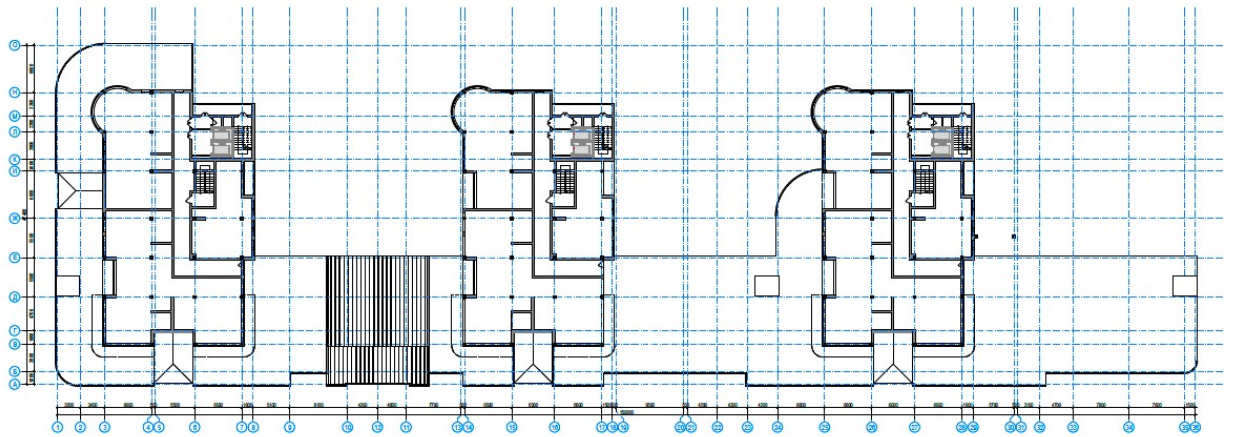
План першого поверху М1:200 на відмітці 0,000
